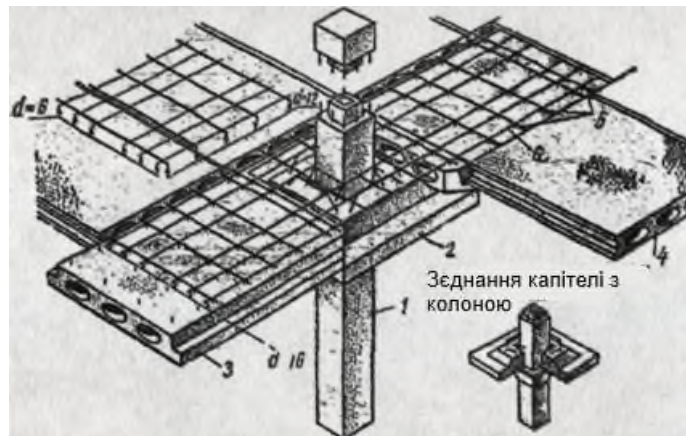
Вузол сполучення конструкції збірно-монолітного безбалочного перекриття ПВІ: 1 - колона; 2 - капітельна плита; 3 - міжколонна плита-балка; 4 - прогонові плити-панелі; 5 - поперечні стрижні-сітки; 6 - поздовжні стрижні сітки
